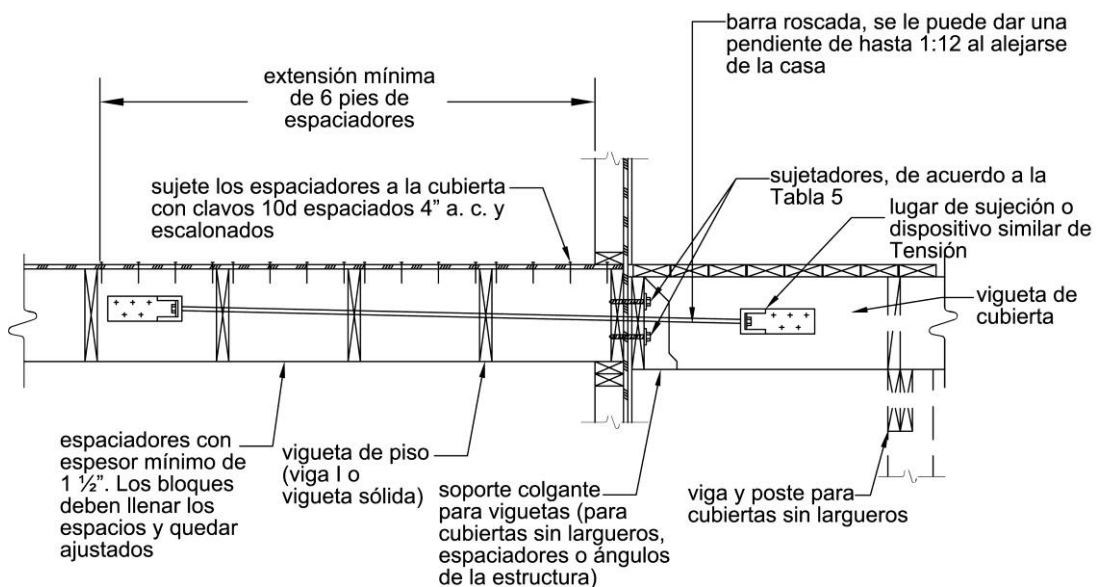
Dispositivo de Carga Lateral con Piso de Viguetas Perpendiculares a las Viguetas de la Cubierta.
